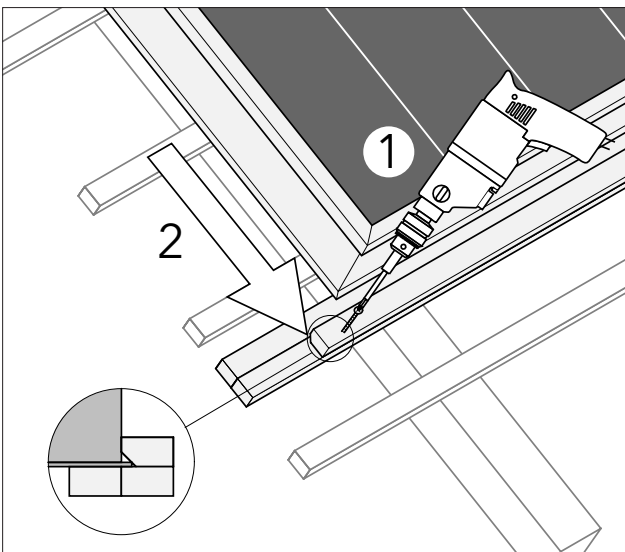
1. Auflagelatten mit ca. 100 mm seitlichem Überstand mit Schnellbauschrauben 4x70 befestigen. 2. Kollektoren in ca. 8 mm Abstand einlegen.
